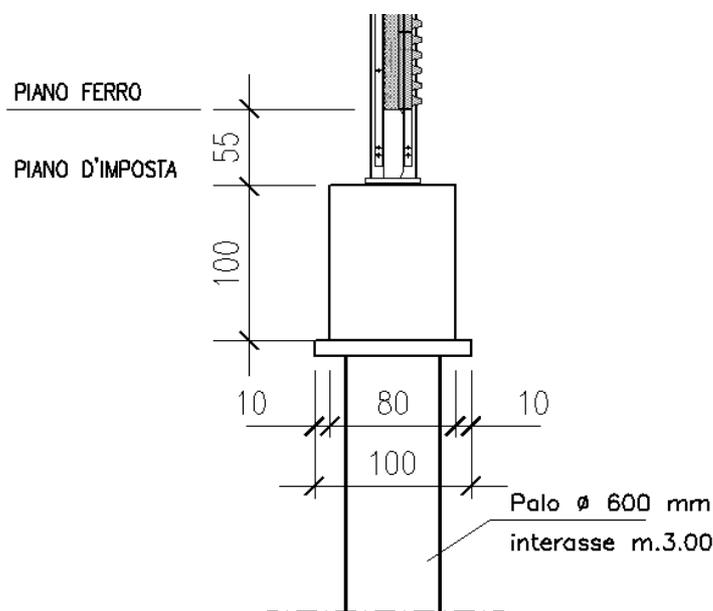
sezione fondazione di linea BFA (BA01÷BA15 e BA18÷BA20)
